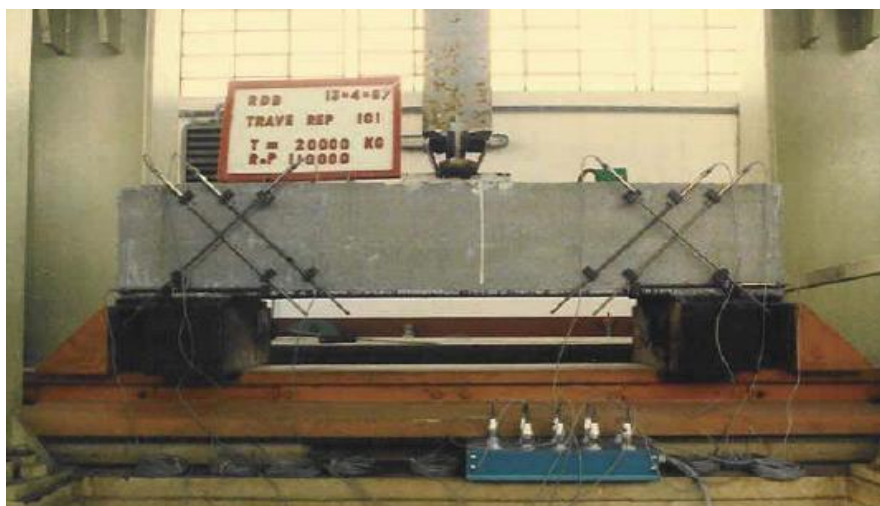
Foto test laboratorio Trave REP®-TMQ
